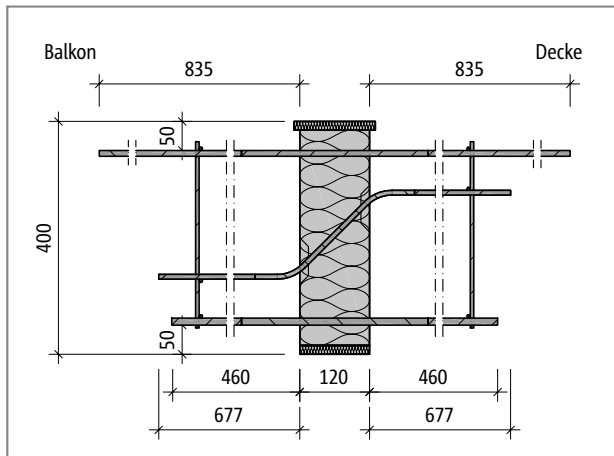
Schöck Isokorb® XT Typ B: Produktschnitt
